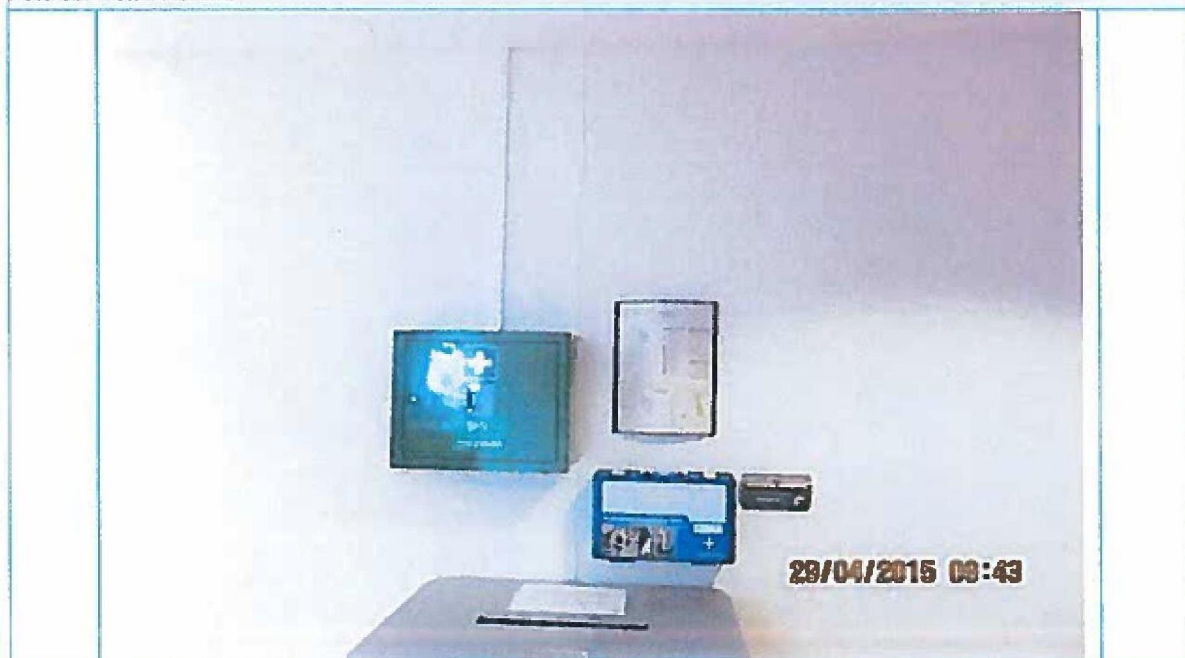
2^e Verdieping, kantoor 2.05. Scheurvorming in stucwerk. Geen gerelateerde bevestigsschade. Aansluiting twee bouwelementen, geen dilatatie.
